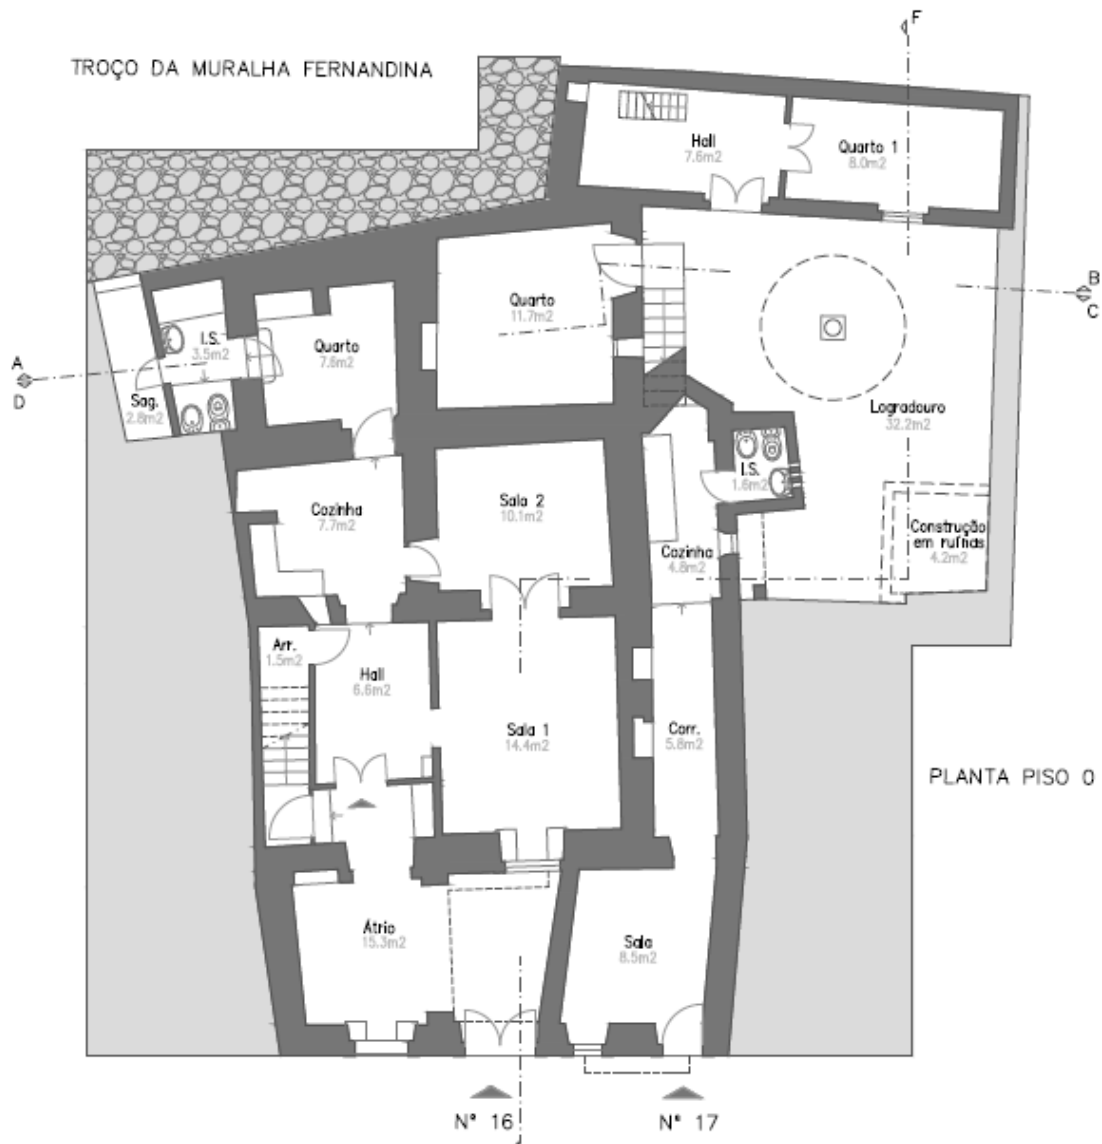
Planta Piso 00 existente (Sousa et al., 2021).
